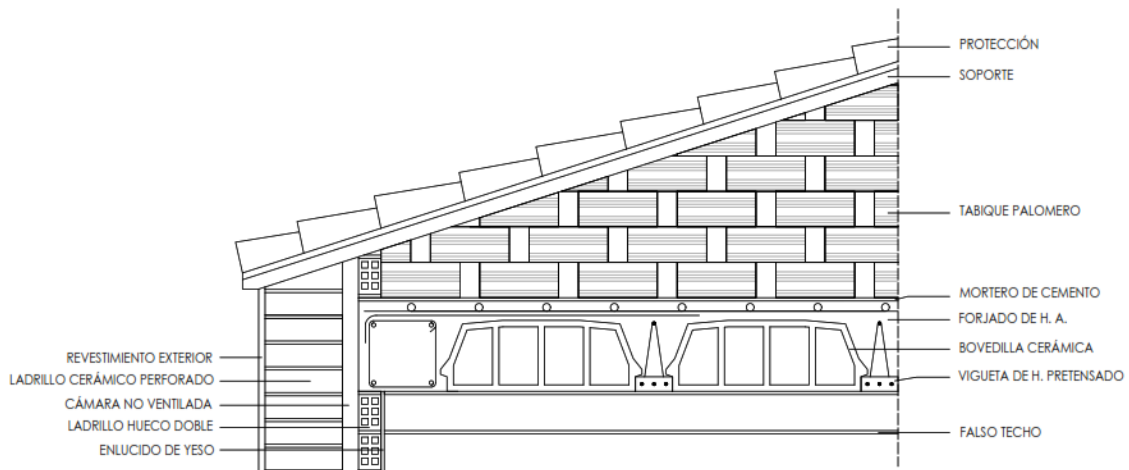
Detalle constructivo del cerramiento en su encuentro con el forjado superior y la cubierta inclinada.
